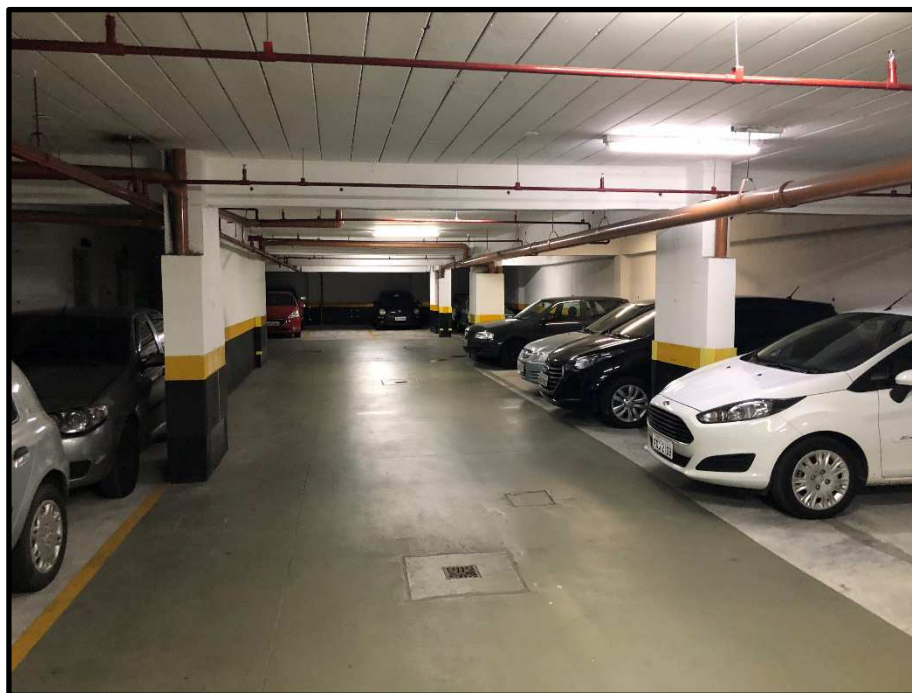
2º subsolo – vagas de garagem – Vista 2
